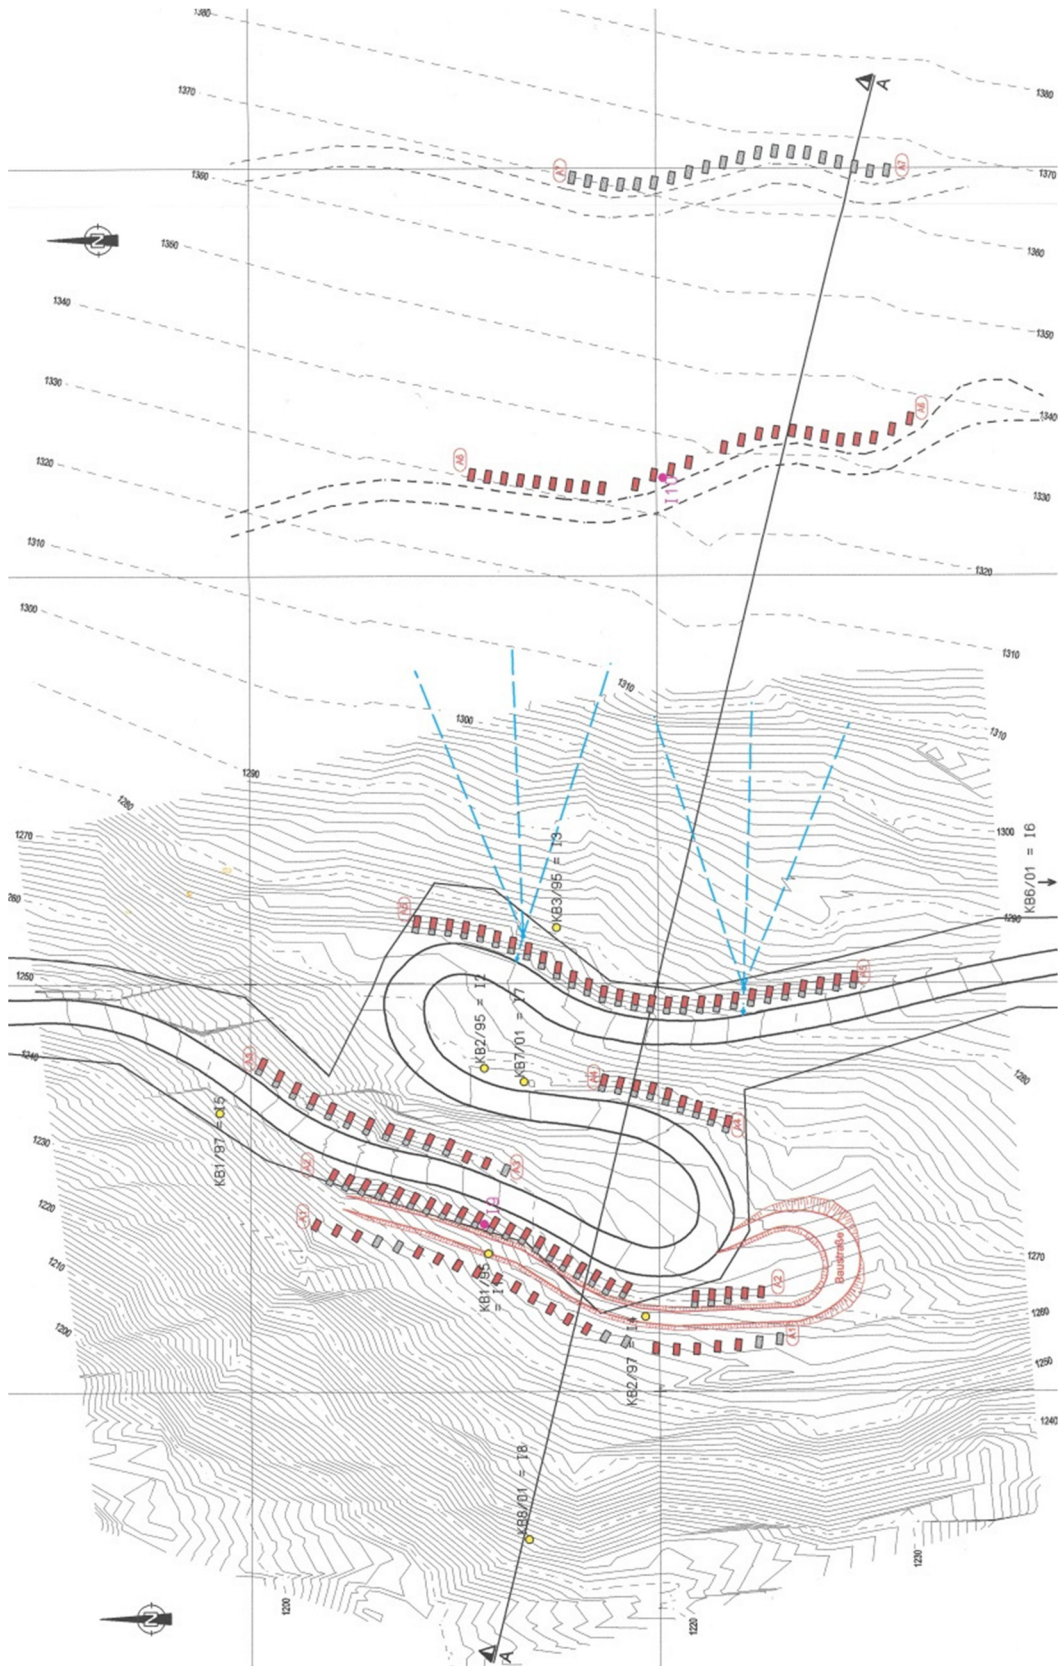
Grundriss zur geplanten Sicherung des Kriechhangs [4]
